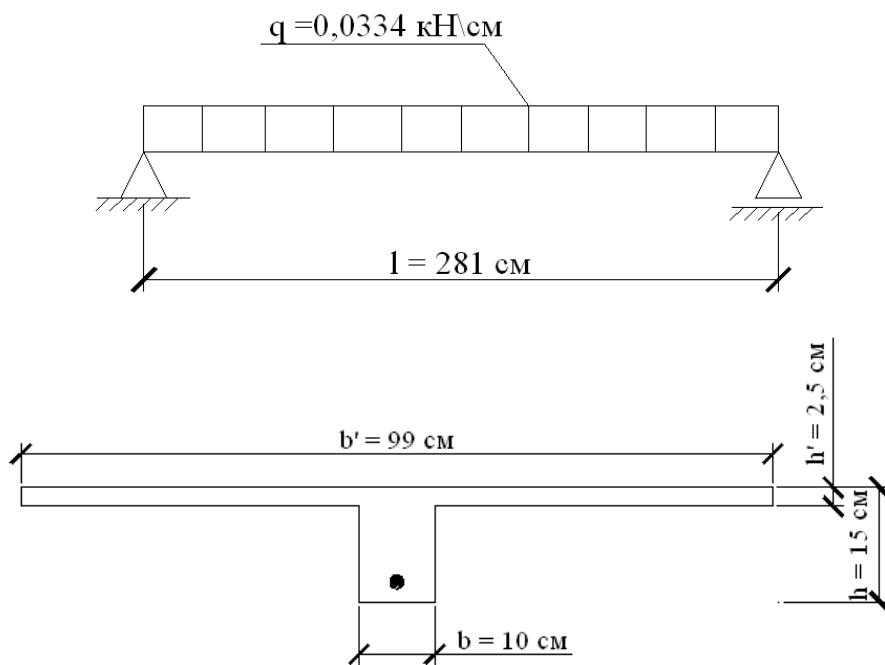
Розрахункова схема та розрахунковий поперечний переріз поперечного ребра
